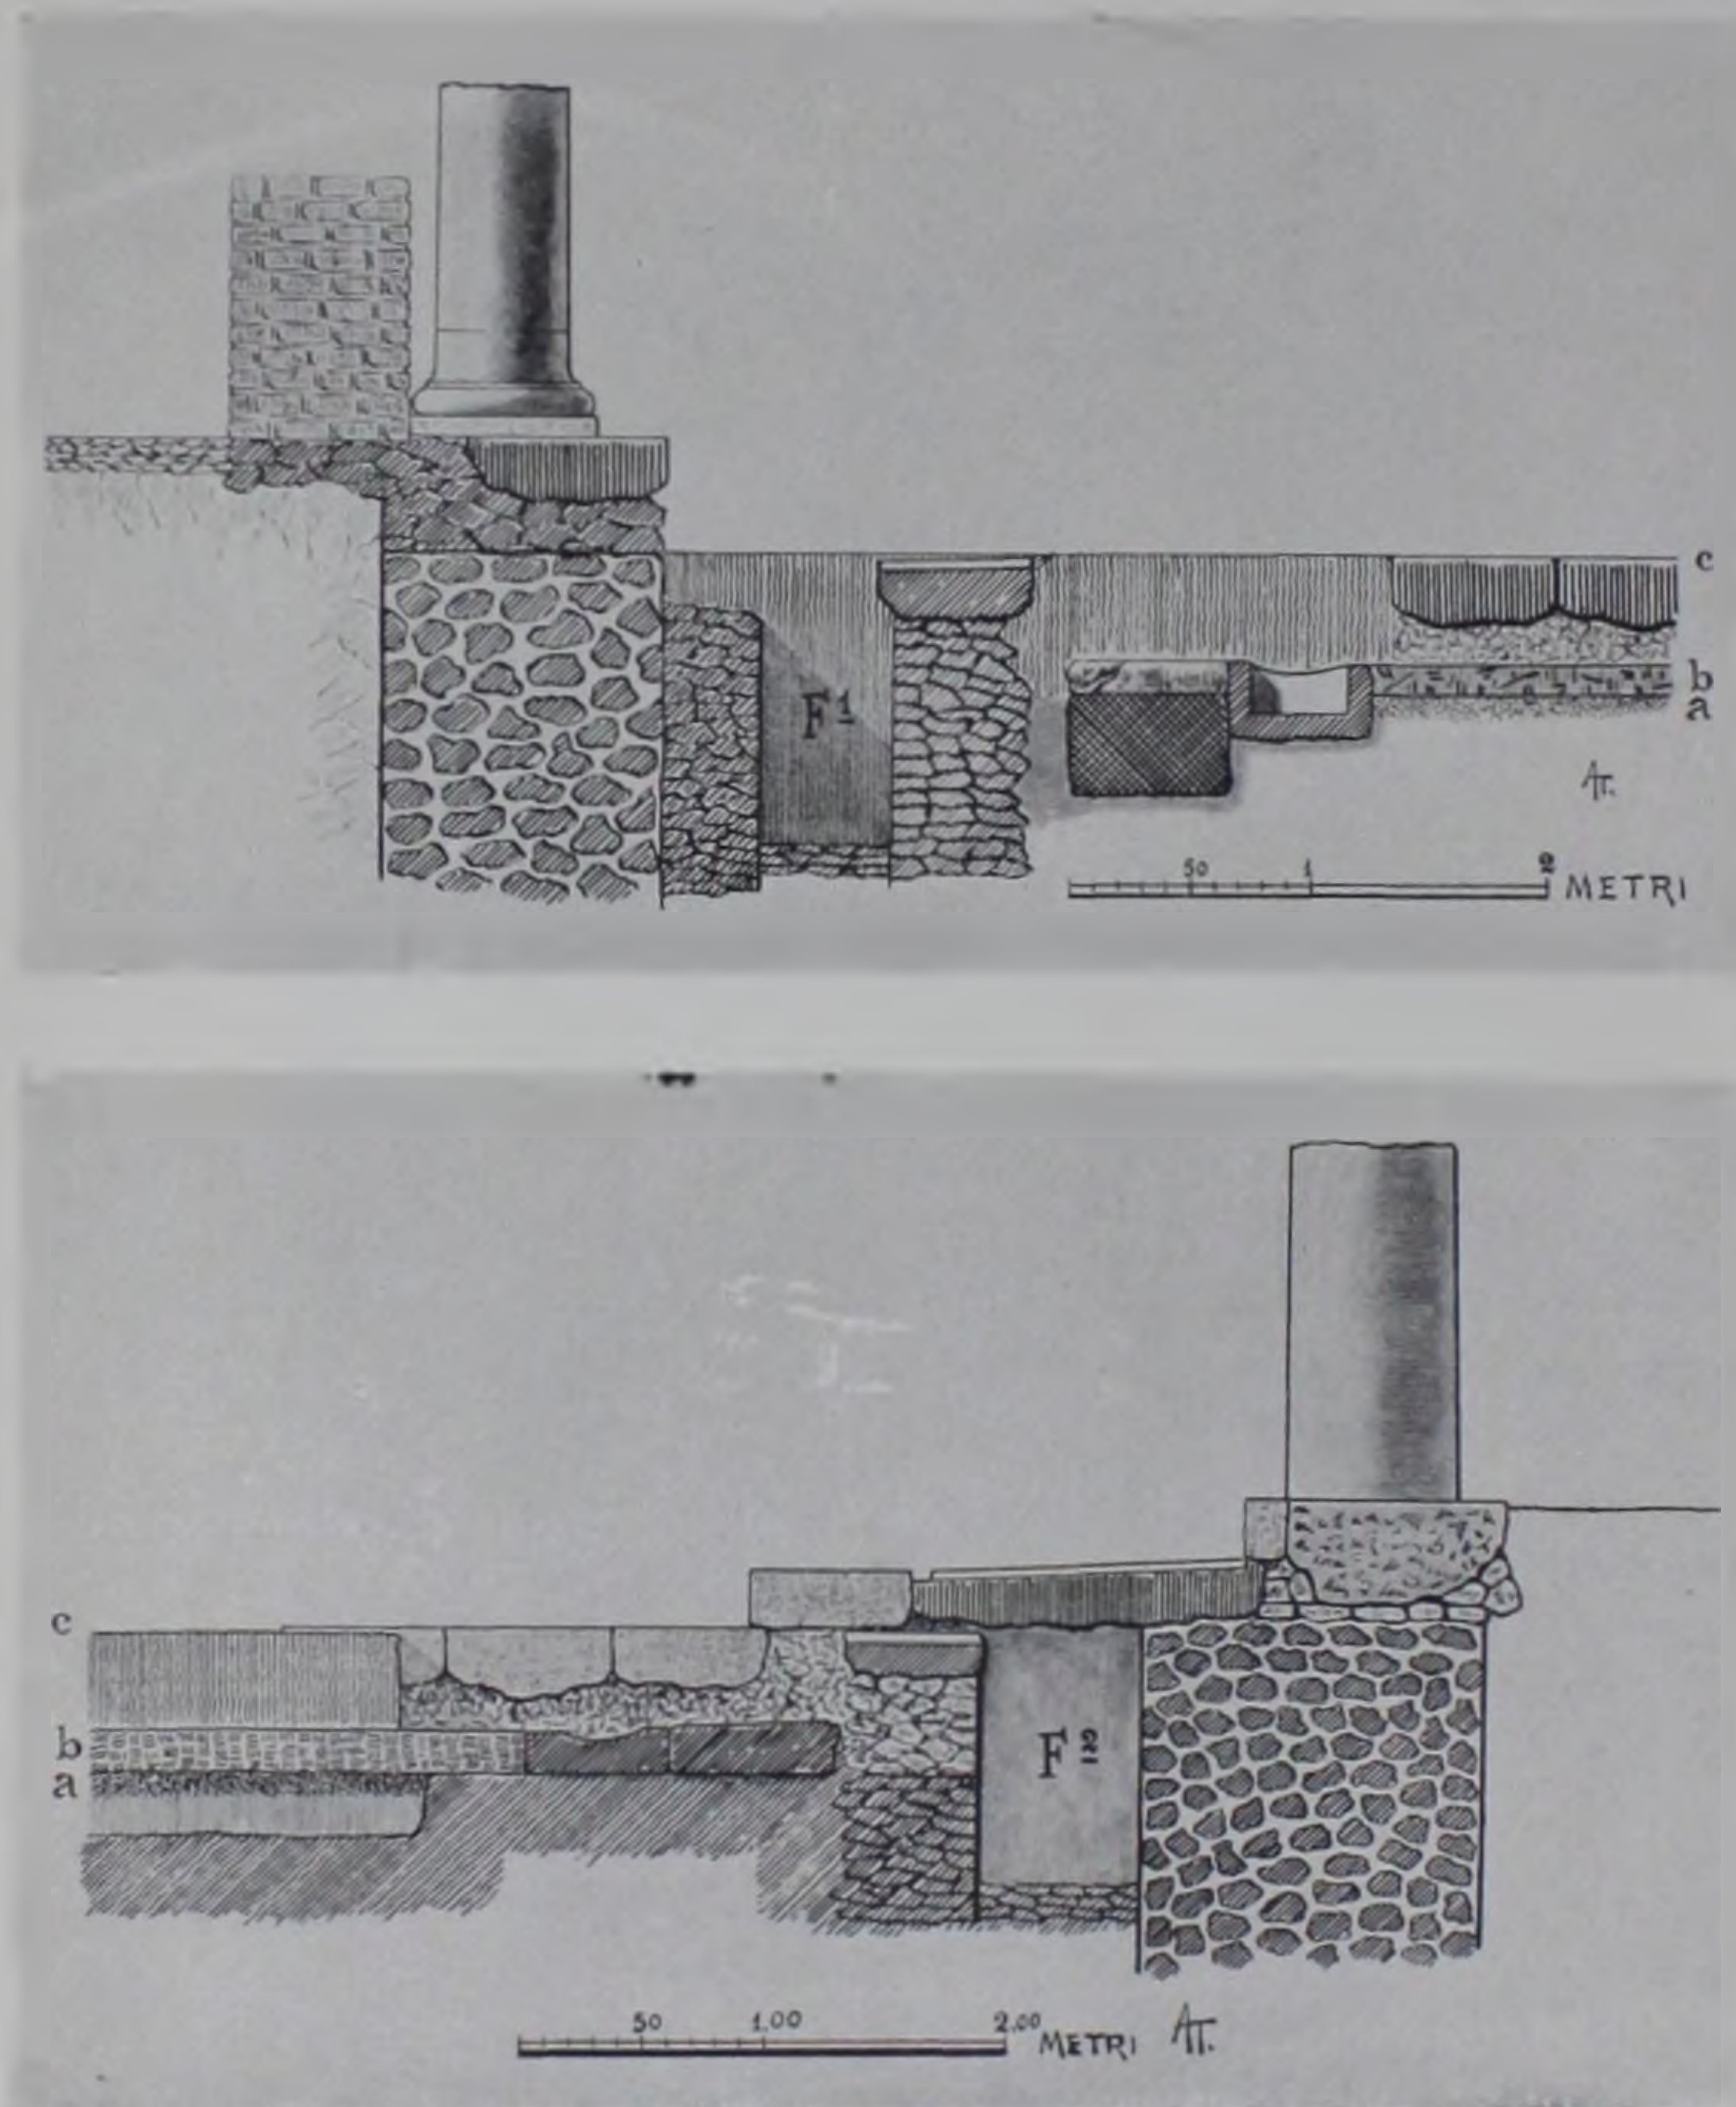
a-b. Strati della pavimentazione del Foro (sezione da est-ovest e da ovest-est).
